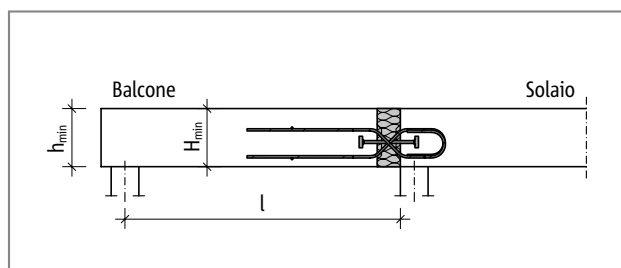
Schöck Isokorb® tipo da QP10S-VV a QP60M-VV: schema statico
